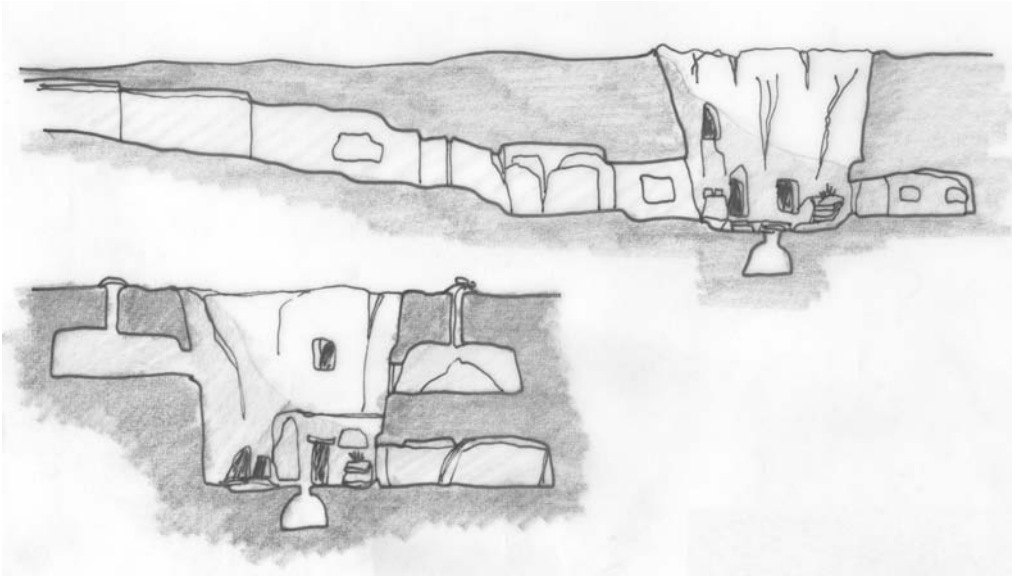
Sezione sul tunnel di accesso e sui granai.
